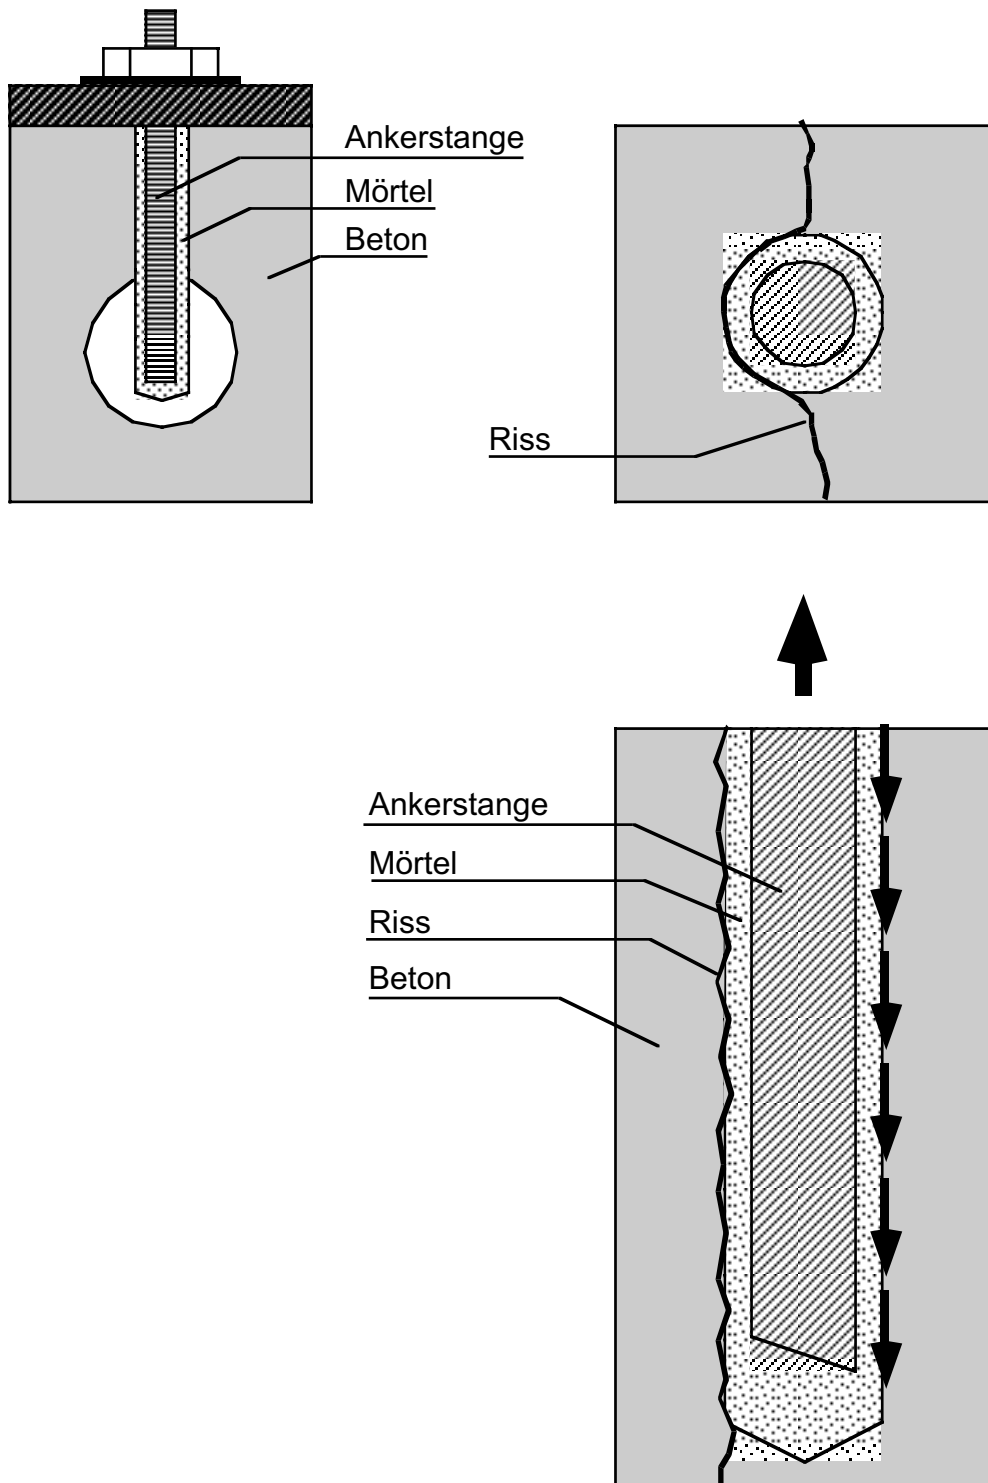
Störung des Verbundes zwischen Mörtel und Beton im gerissenen Beton
